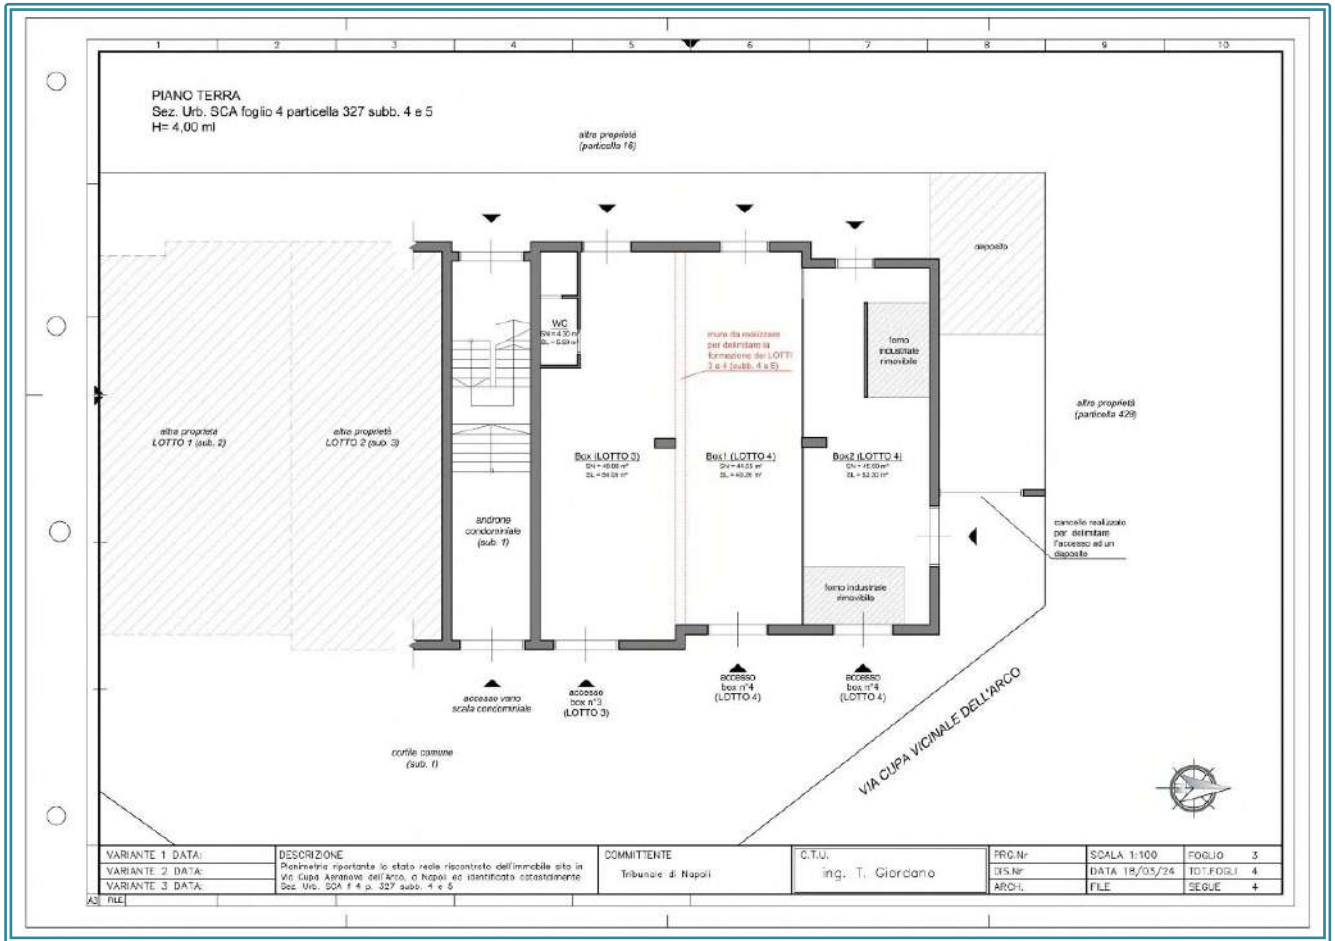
Planimetria stato attuale LOTTI 3 e 4
